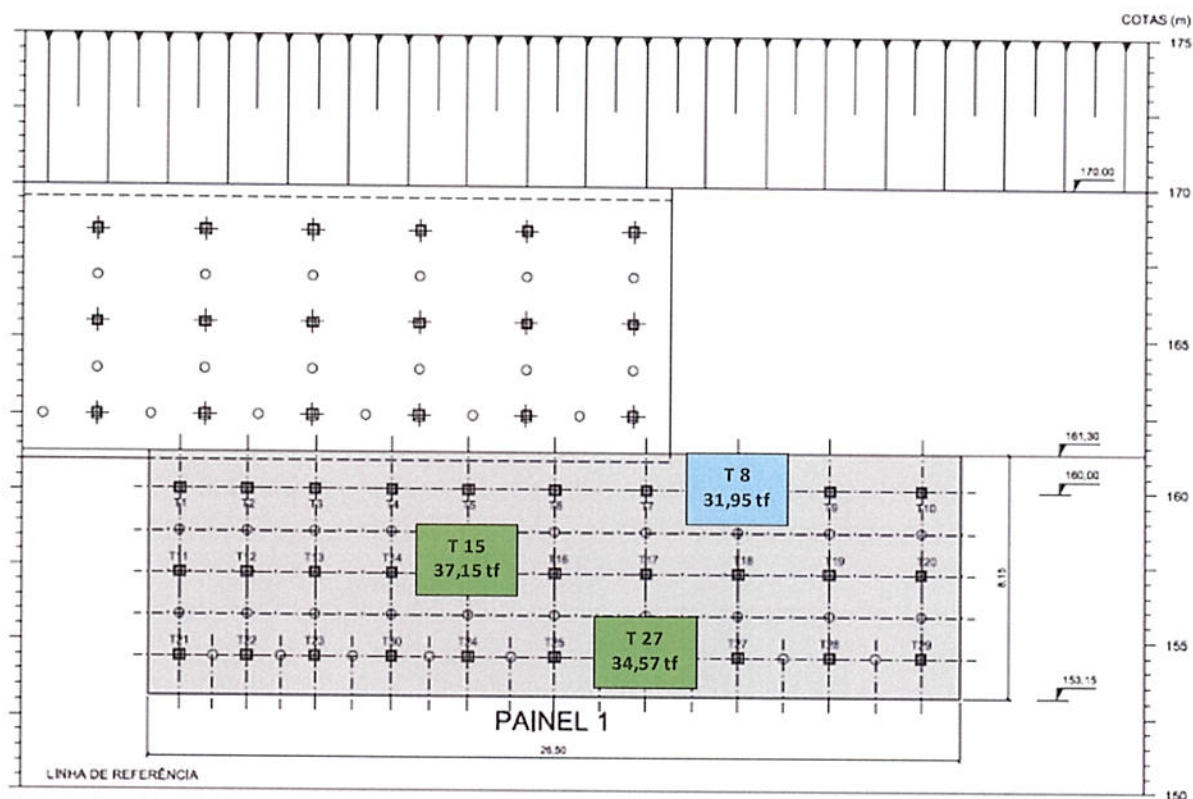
Imagem da Cortina entre as elevações entre 153 e 160.
